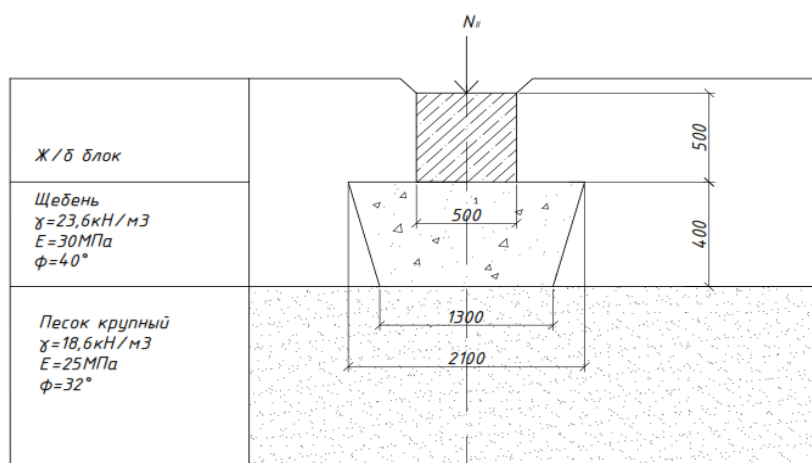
Расчетная схема монолитного фундамента с подстилающим слоем
